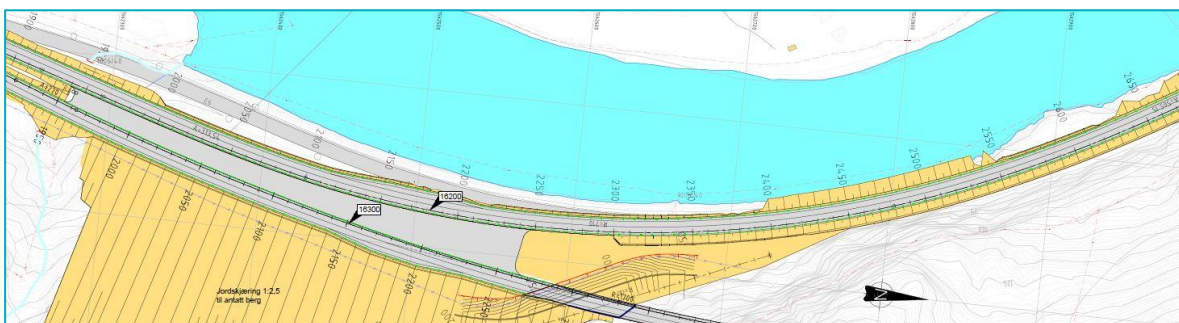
Tunnelportal i sør – utsnitt fra teknisk plan. Kilde: Norconsult.
